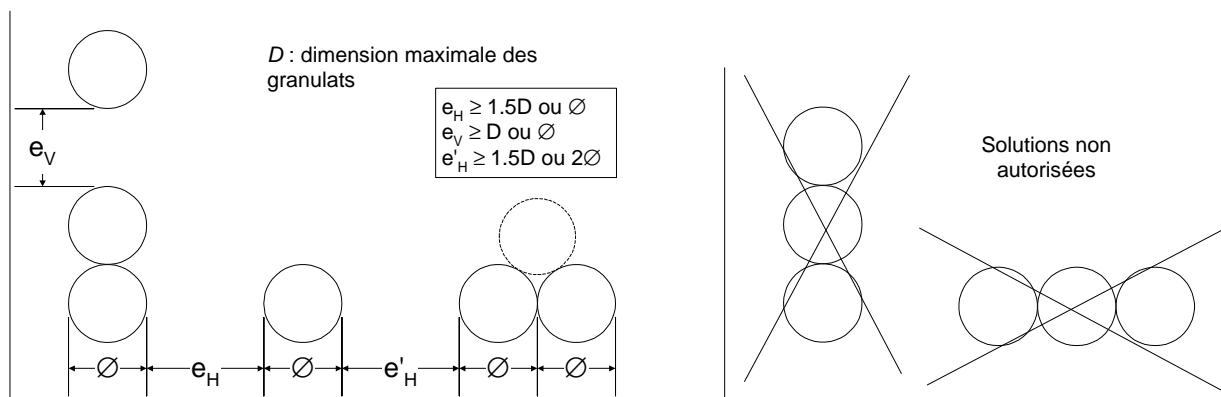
Dispositions constructives pour les groupements d'armatures
